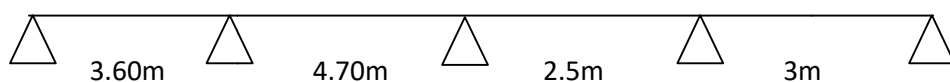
Schéma statique de la poutrelle à 4 travées
